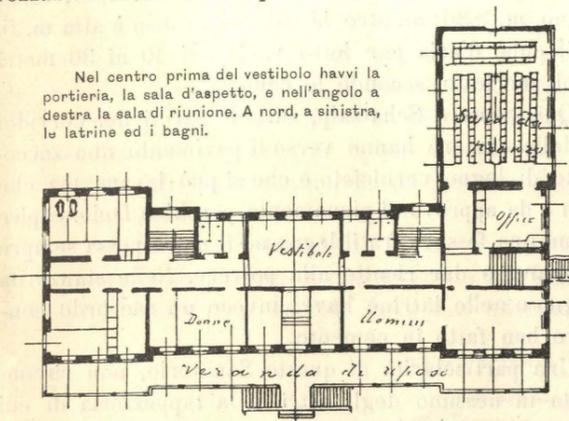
Pianta del pian terreno (Scala di 1:700).
